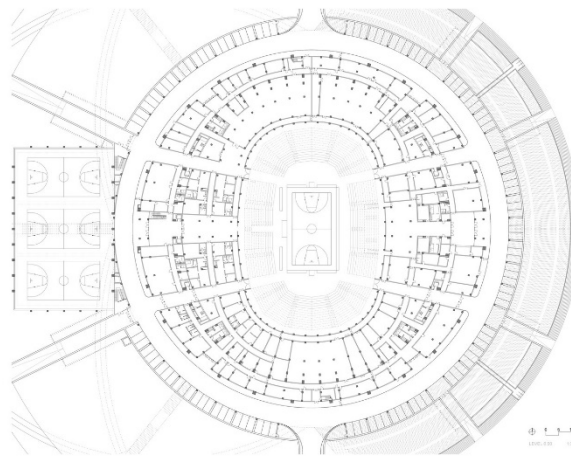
Planta del Estadio de Basketball en Dongguan.
